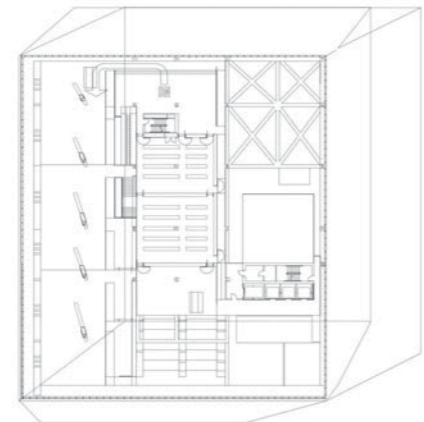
Planta de Piso 10 - Sala de Leitura.
